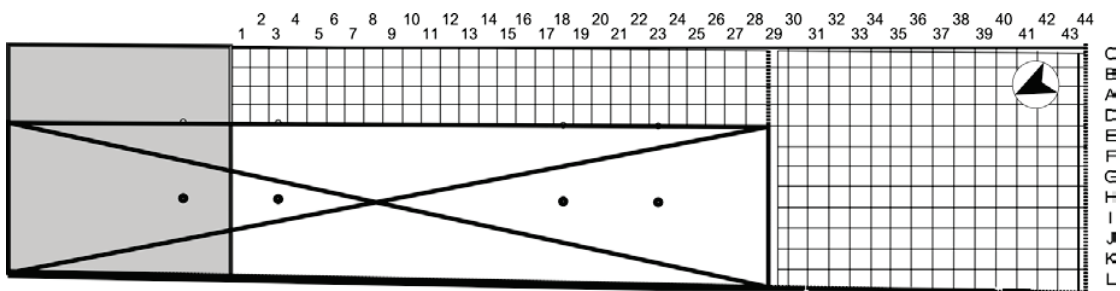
Planta de del Lote 2 mostrando el sistema de cuadrículado utilizado. Con trazos cruzados se muestra el sótano, en gris zona no excavada por no estar contemplado dentro del plan de obra civil.
